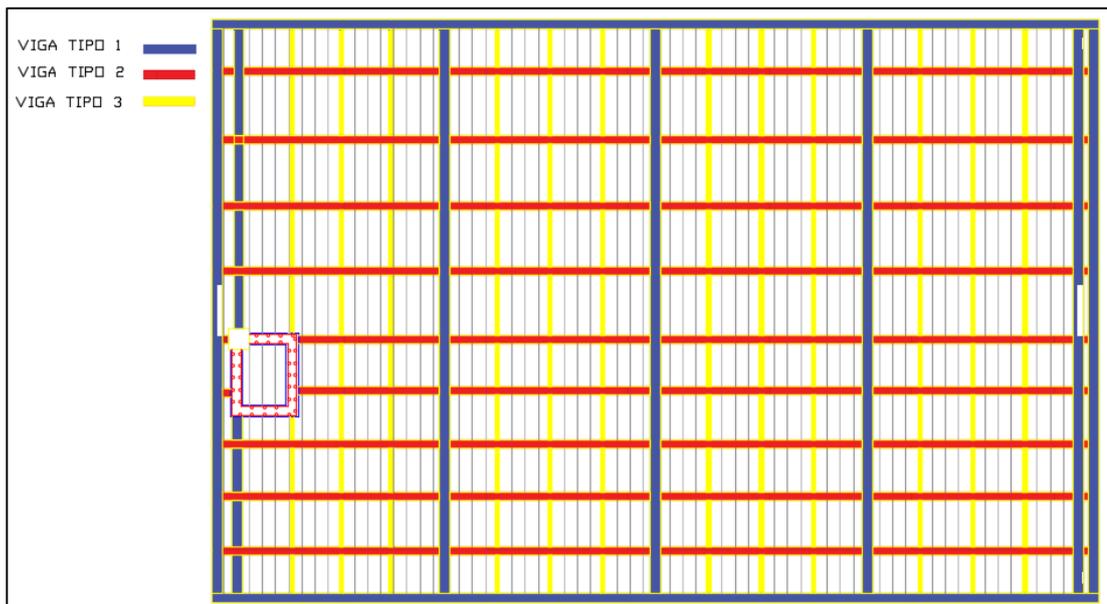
Esquema de distribución de tipos de vigas N+8,10 (Acero)
